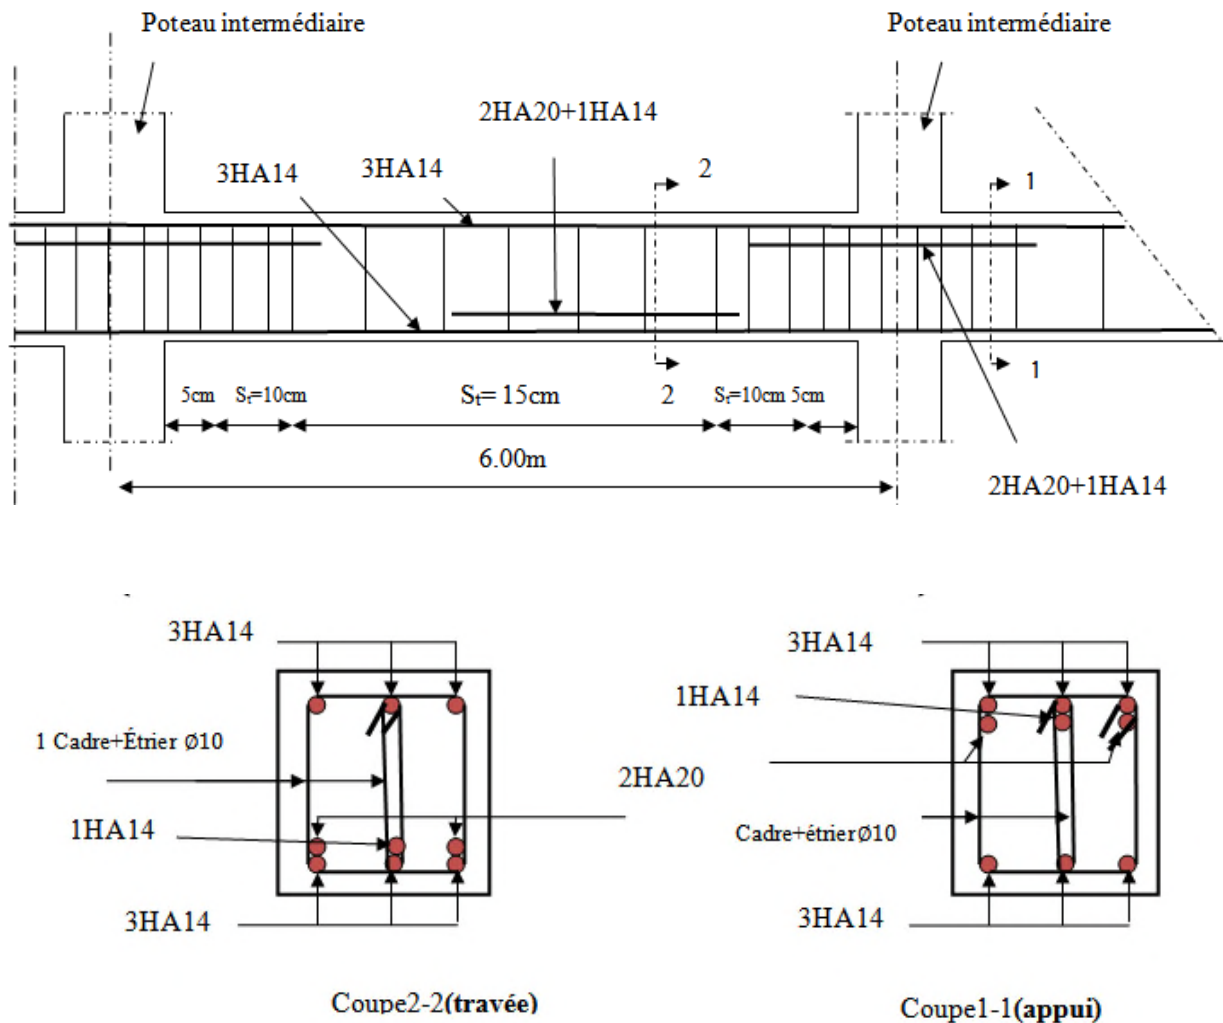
Schéma de ferrailage des poutres secondaire de RDC
